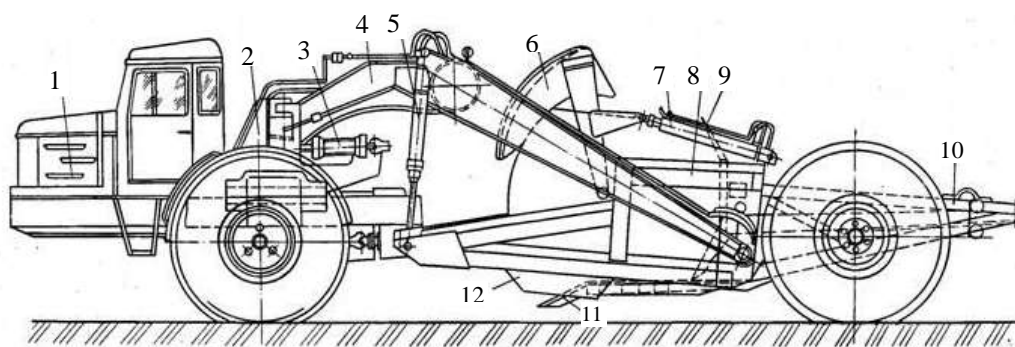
Самохідний скрепер: 1 – тягач; 2 – сидельно-зчіпний пристрій; 3 – циліндр поверту тягача; 4 – рама; 5 – циліндр піднімання і опускання ковша; 6 – заслінка; 7 – циліндр керування передньою заслінкою; 8 – ківш; 9 – задня стінка; 10 – циліндр задньої стінки; 11 – горизонтальні ножі; 12 – бокові ножі
